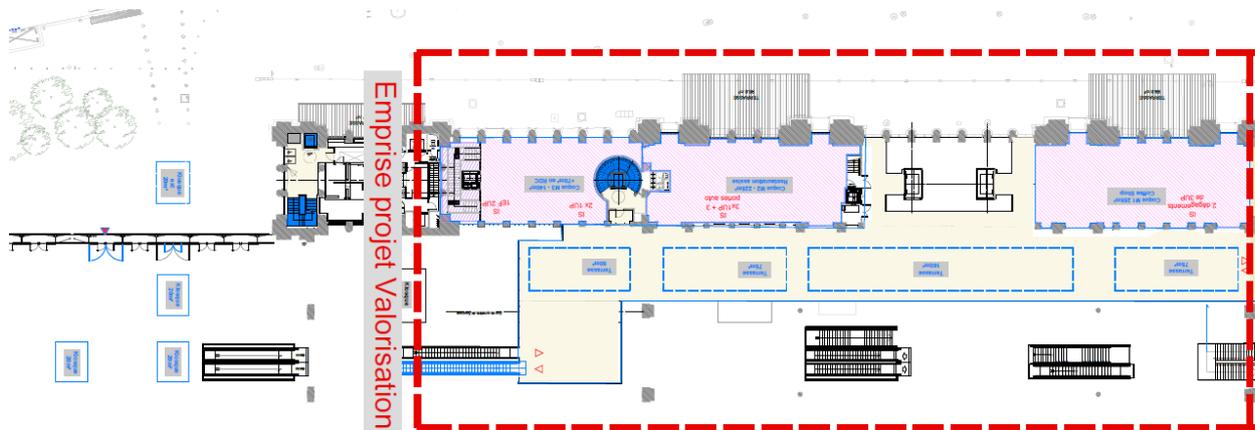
La mezzanine du Terminal Transmanche en situation future (Source : Gares & Connexions)
